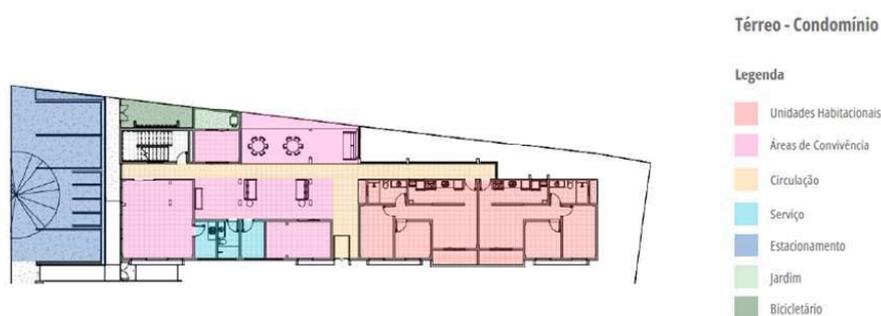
Planta Baixa Térreo Condomínio com setorização
